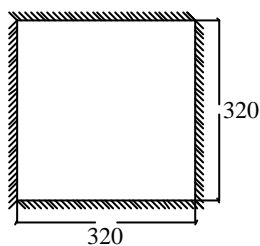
Representação das condições de apoio da laje de fundo para o reservatório elevado (dimensões em cm).
